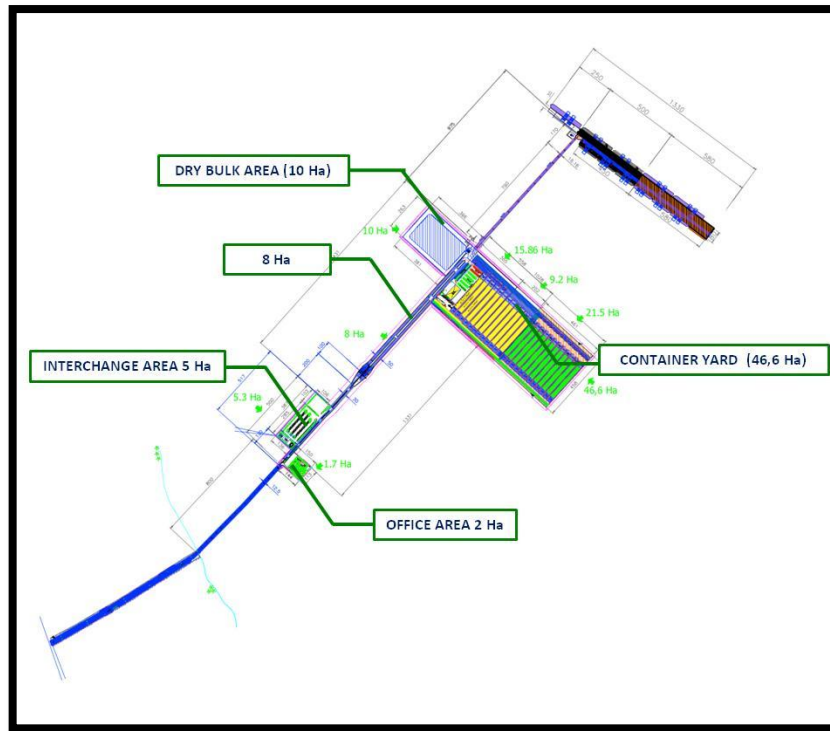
Fase pertama Pembangunan PT Terminal Teluk Lamong
